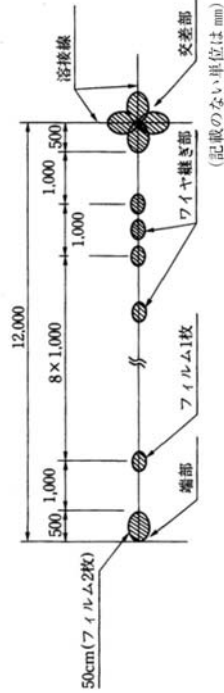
鋼床版デッキプレートのX線撮影箇所例
